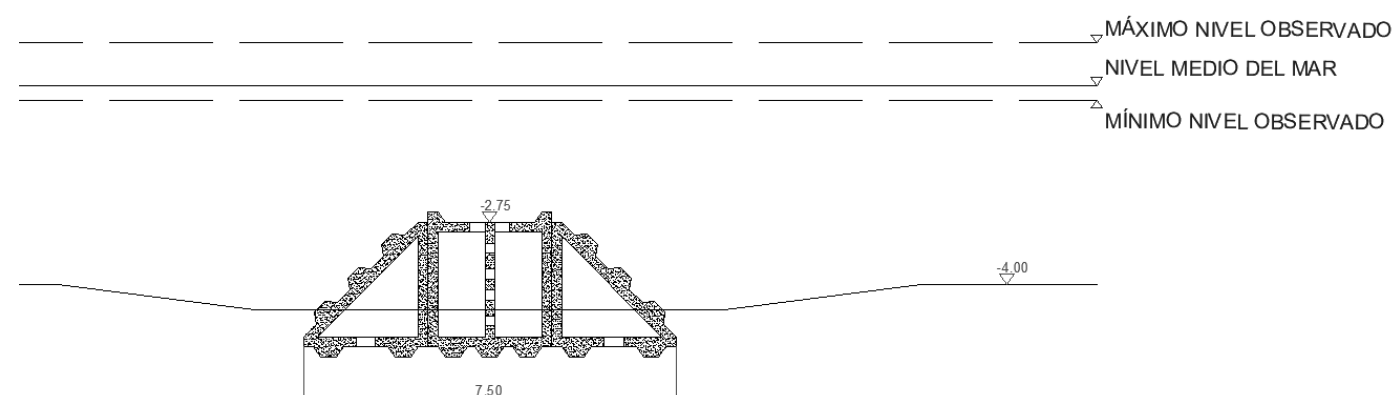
Prediseño de configuración TCT con estructuras modulares. (Fuente: plano 6, 2023).
